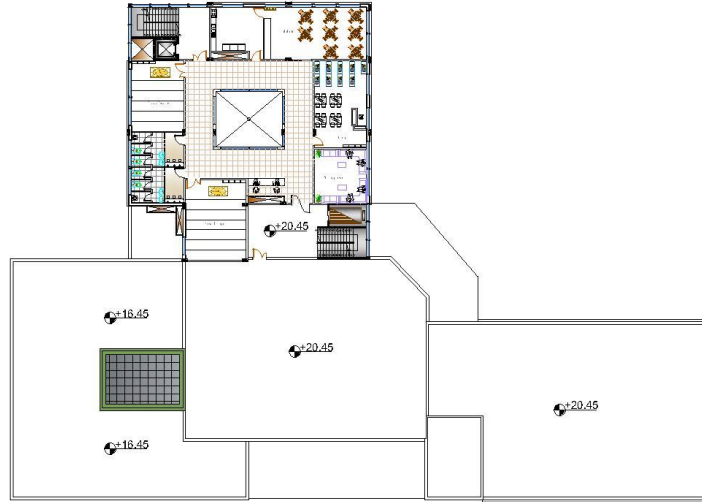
المسقط الأفقي للطابق الثالث
